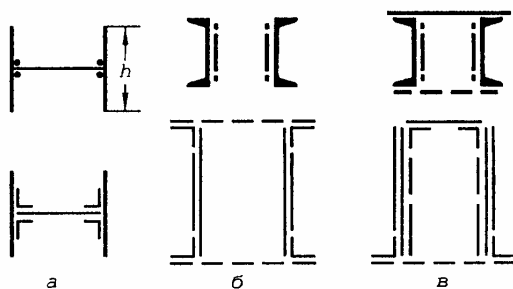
Типи перерізів стержнів великопролітних ферм:
